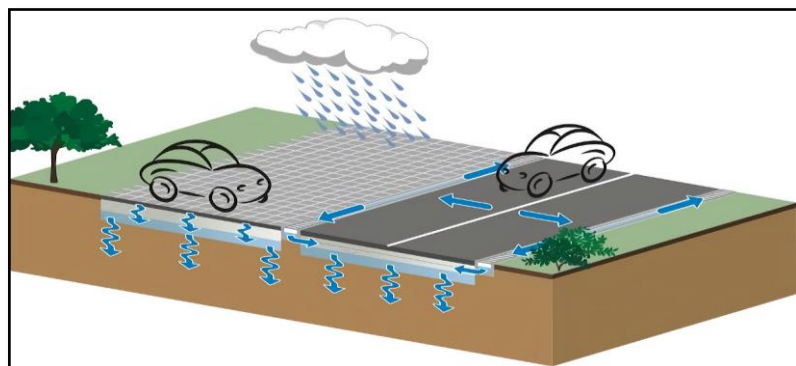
Chaussée avec enrobés imperméables a structure réservoir
